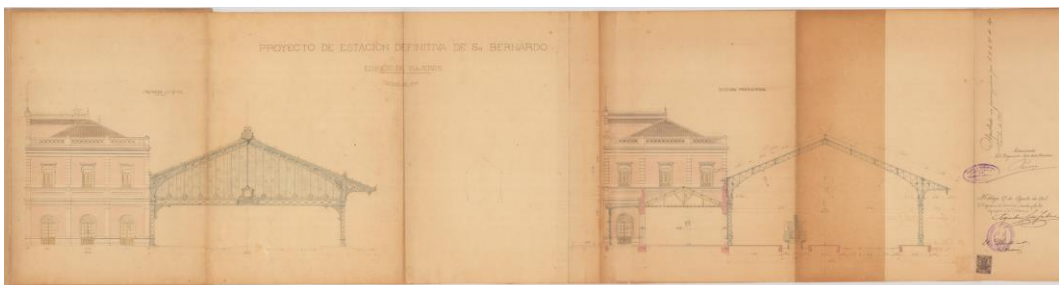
Proyecto de estación definitiva de "San Bernardo"; edificio de viajeros, fachada lateral y sección transversal
